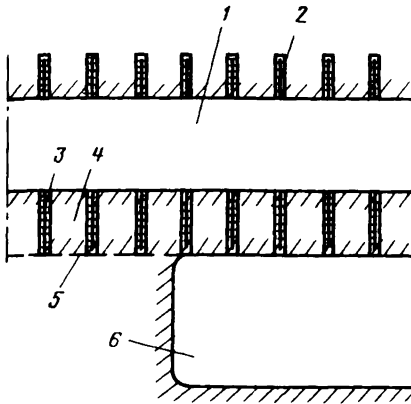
Схема предварительного укрепления массива адгезионными анкерами, размещенными в кровле намечаемой к проходке выработки
